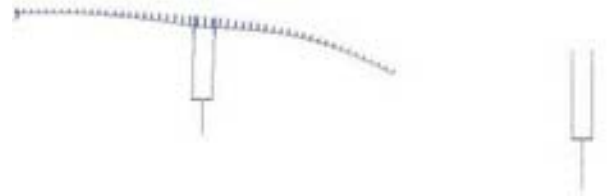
Instante de cálculo con RM2006. Autolanzamiento
